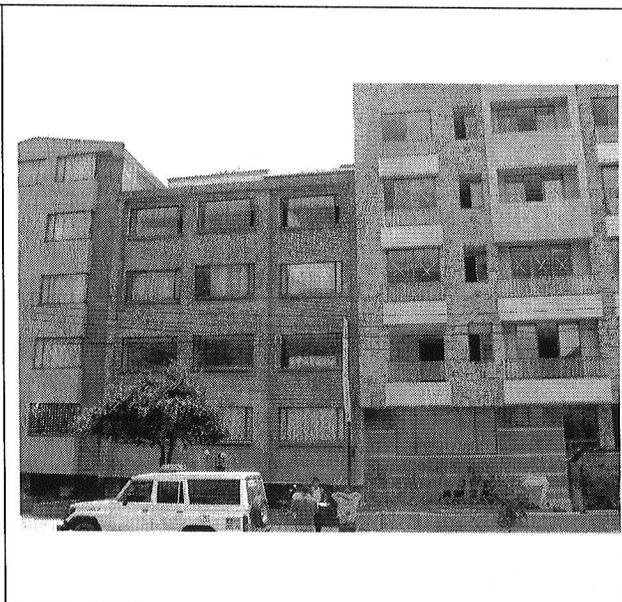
Zona de contacto entre los edificios de la Calle 145A No. 21-48 (derecha) y de la Calle 145A No. 21-52. Apréciase la inexistencia de junta de dilatación.
